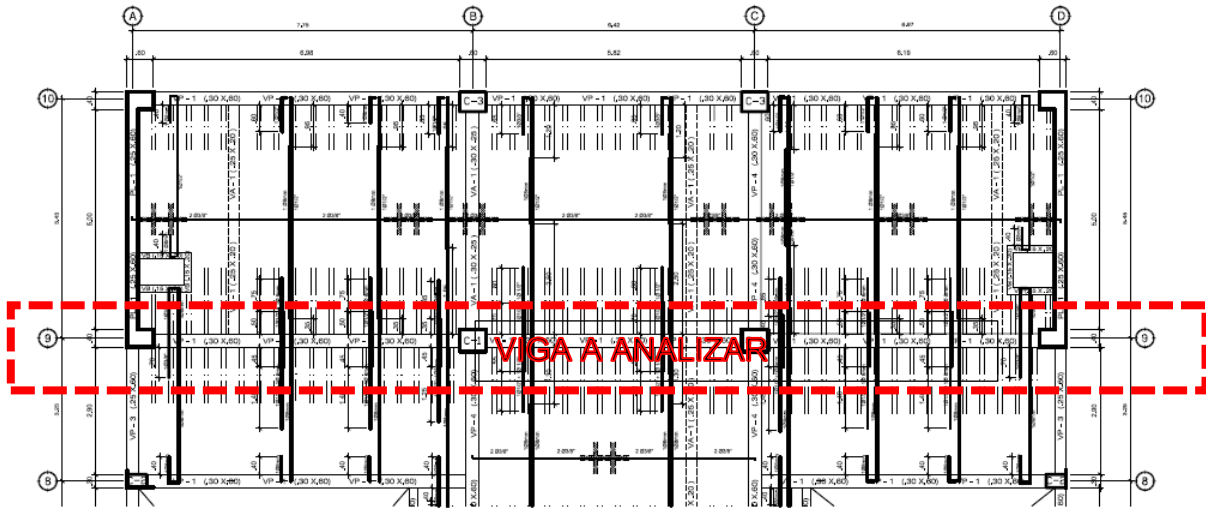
Viga a analizar para el metrado de cargas
